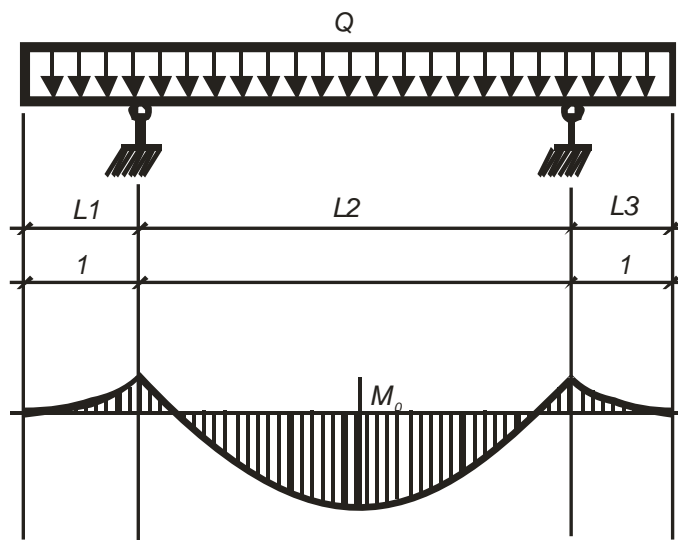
Расчётная схема при транспортировке сваи
